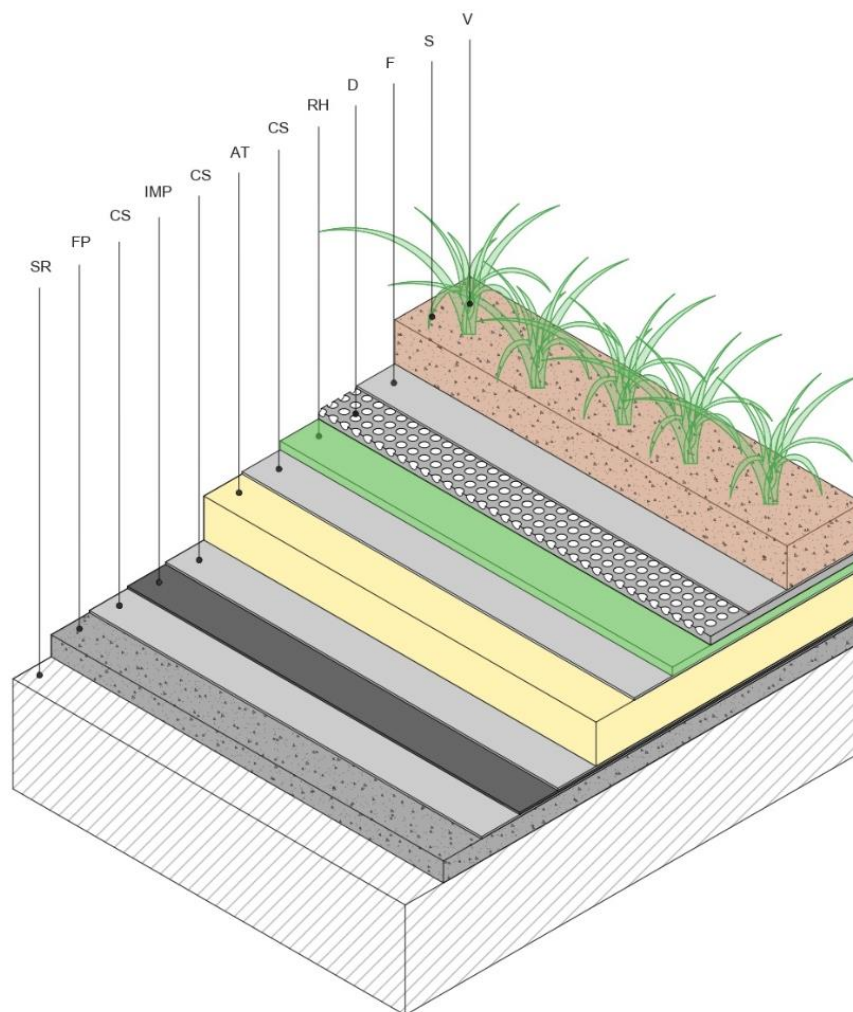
Detalle constructivo colocación capa retenedora en cubierta invertida (2).
